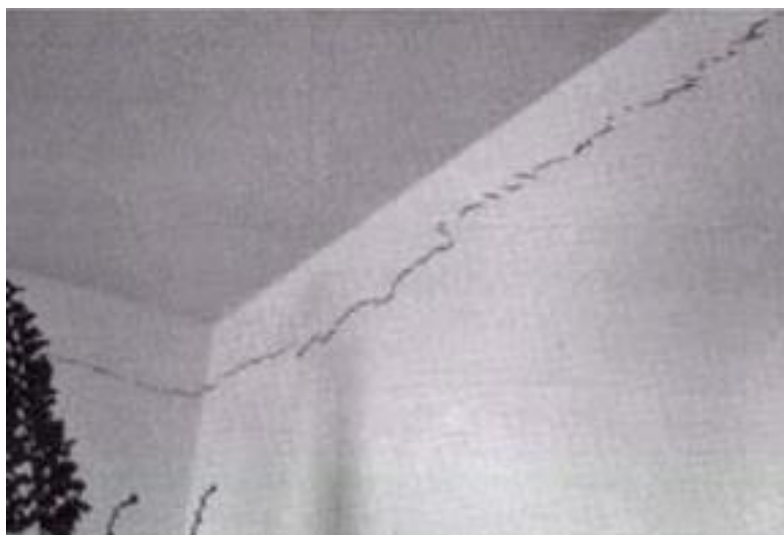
Manifestação Patológica de Fissuração ocasionada por Movimentação térmica da Laje de Cobertura
